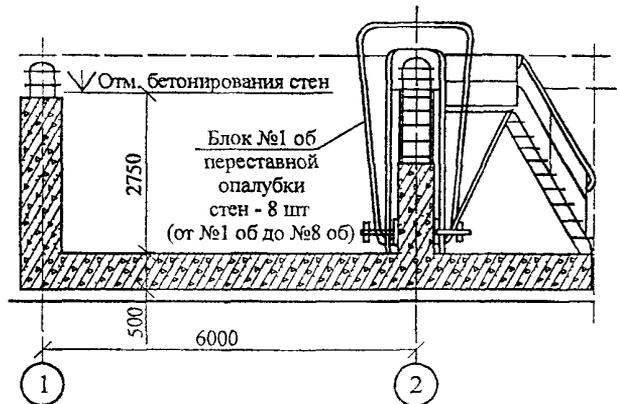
Схемы установки блочной опалубки и укладки бетонной смеси
